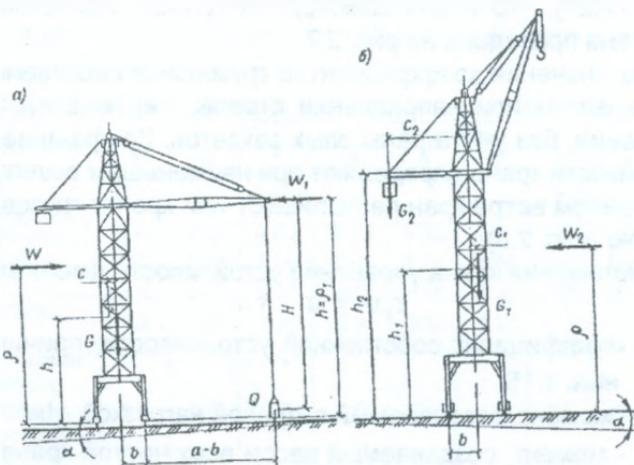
Расчетная схема устойчивости башенного крана с грузом (а) и без груза (б)
